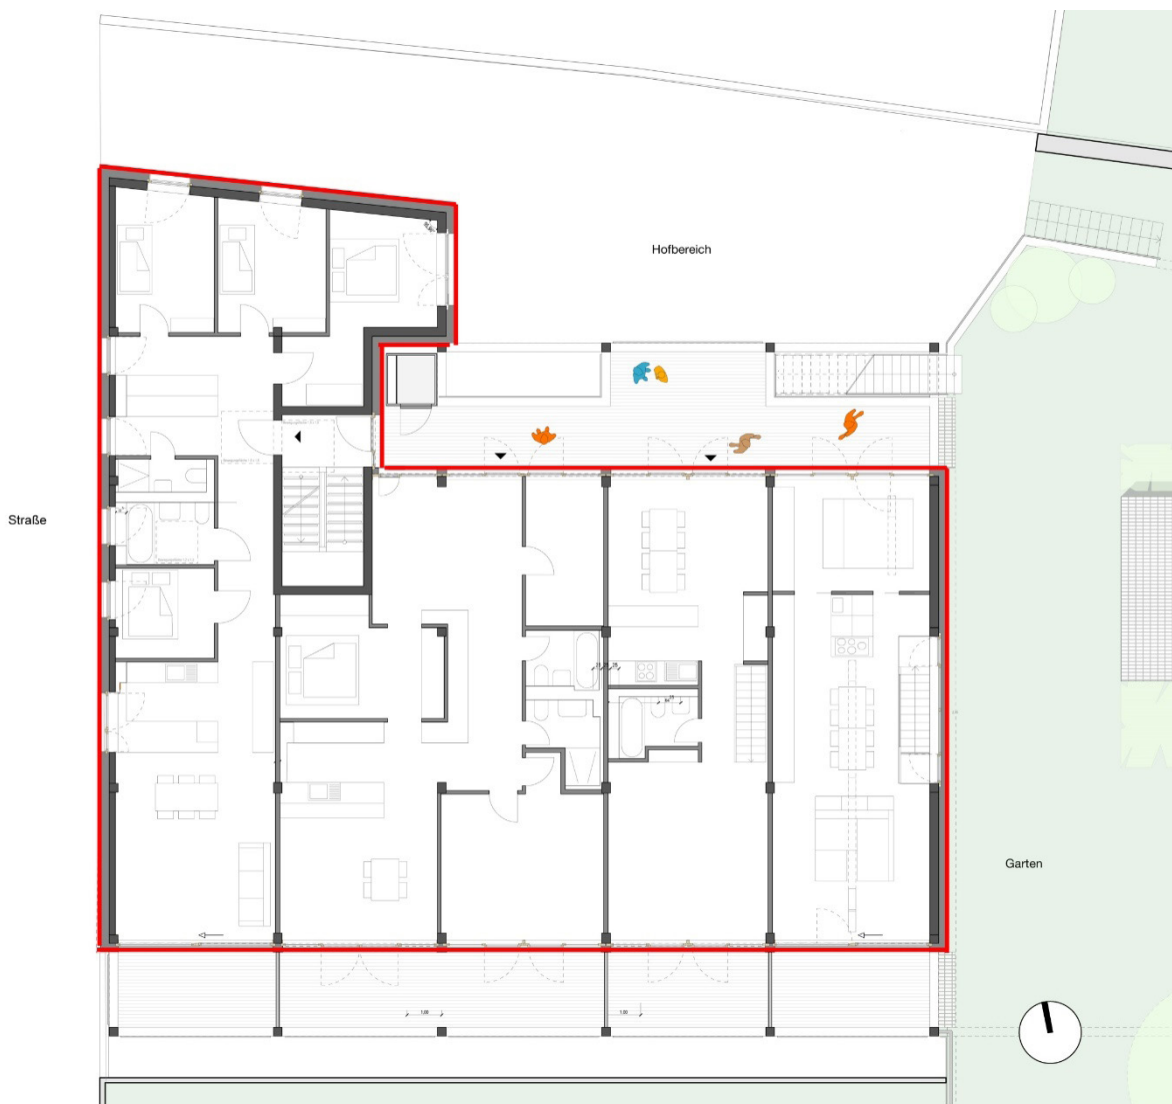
Grundriss K76, thermische Hülle ¹³
